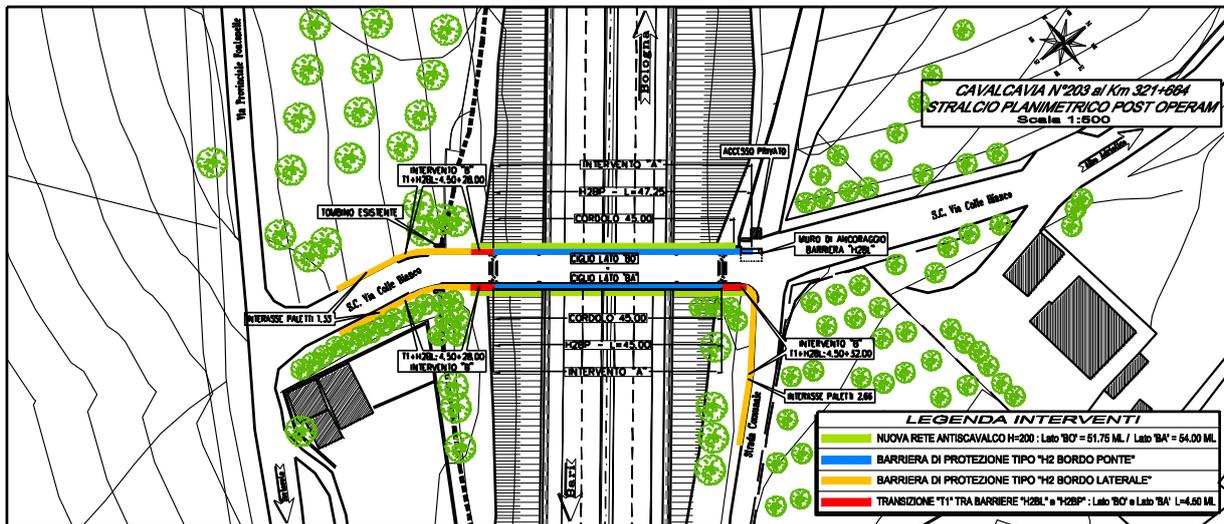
G – Planimetria di Progetto Cavalcavia n.203.
